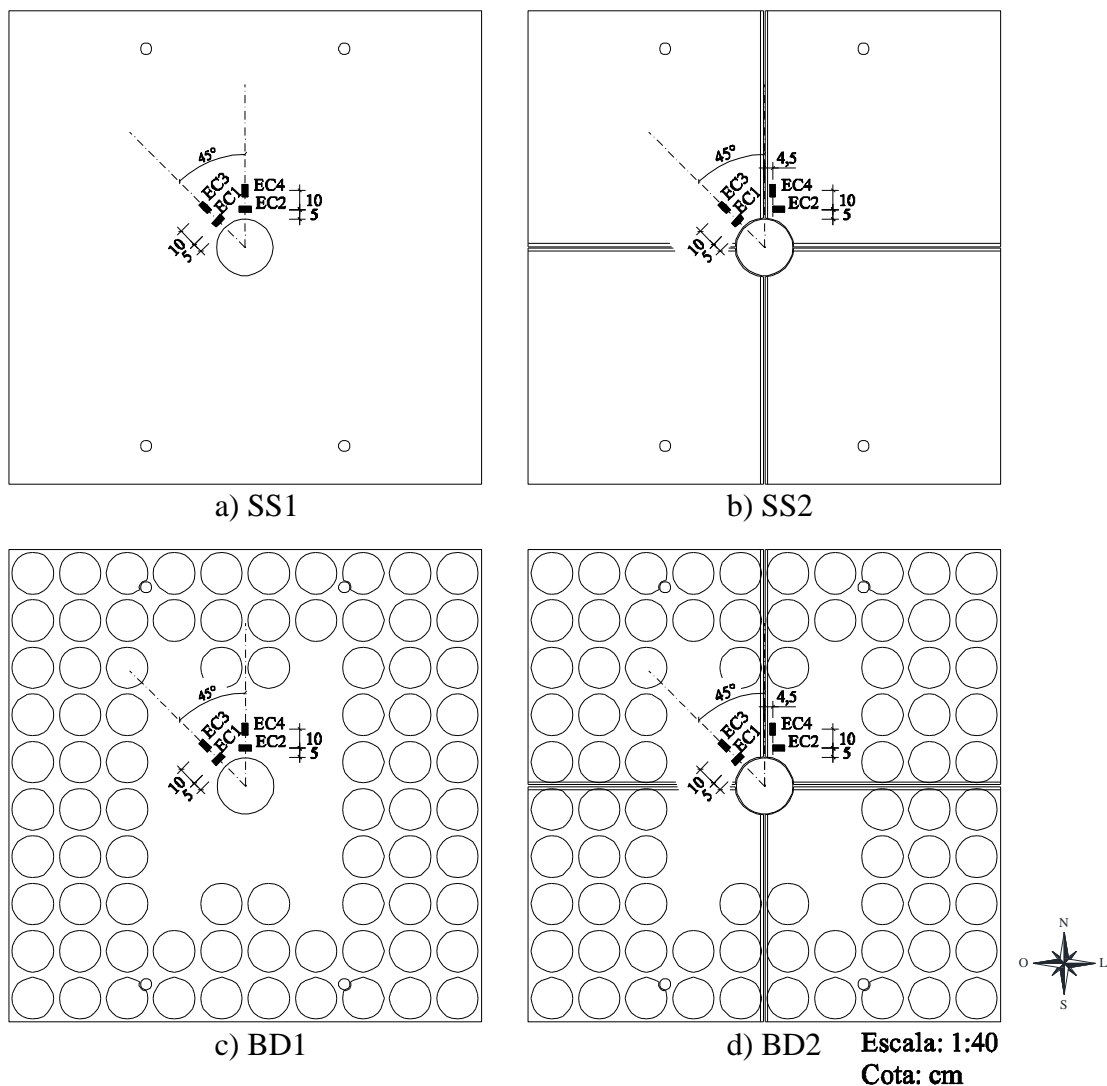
Posição dos extensômetros do concreto (EC) – vista em planta
